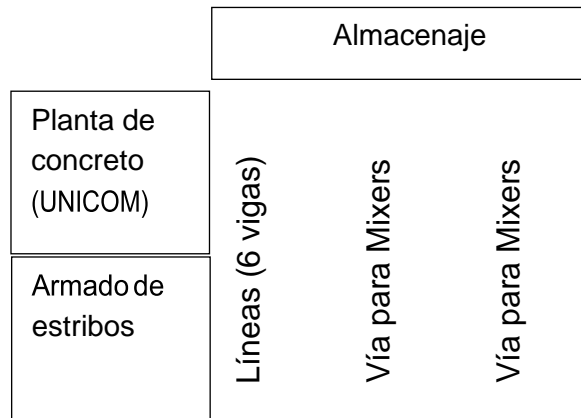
Layout de la planta de vigas de concreto prefabricadas para el proyecto del Tren Eléctrico.
